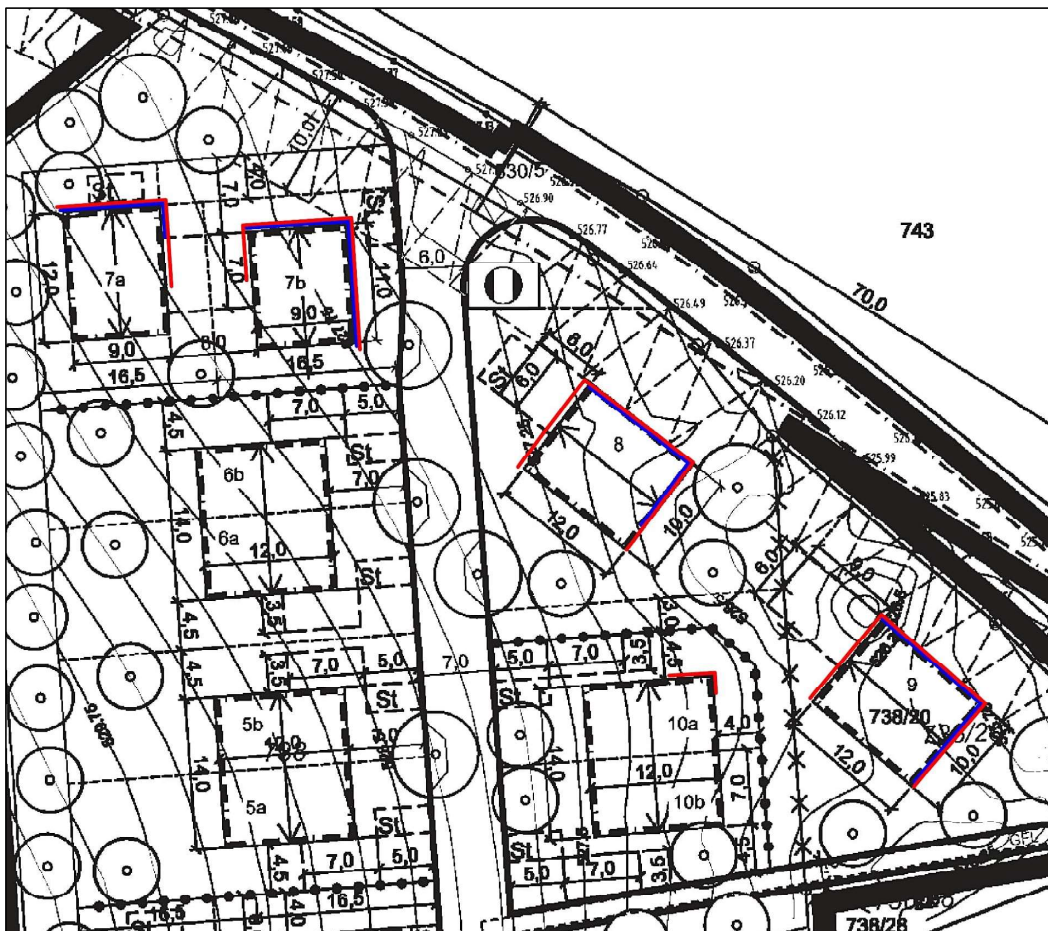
Lageplan mit Kennzeichnung der Fassaden an denen Außenwohnbereiche im Erdgeschoss und Obergeschoss geschützt werden müssen
